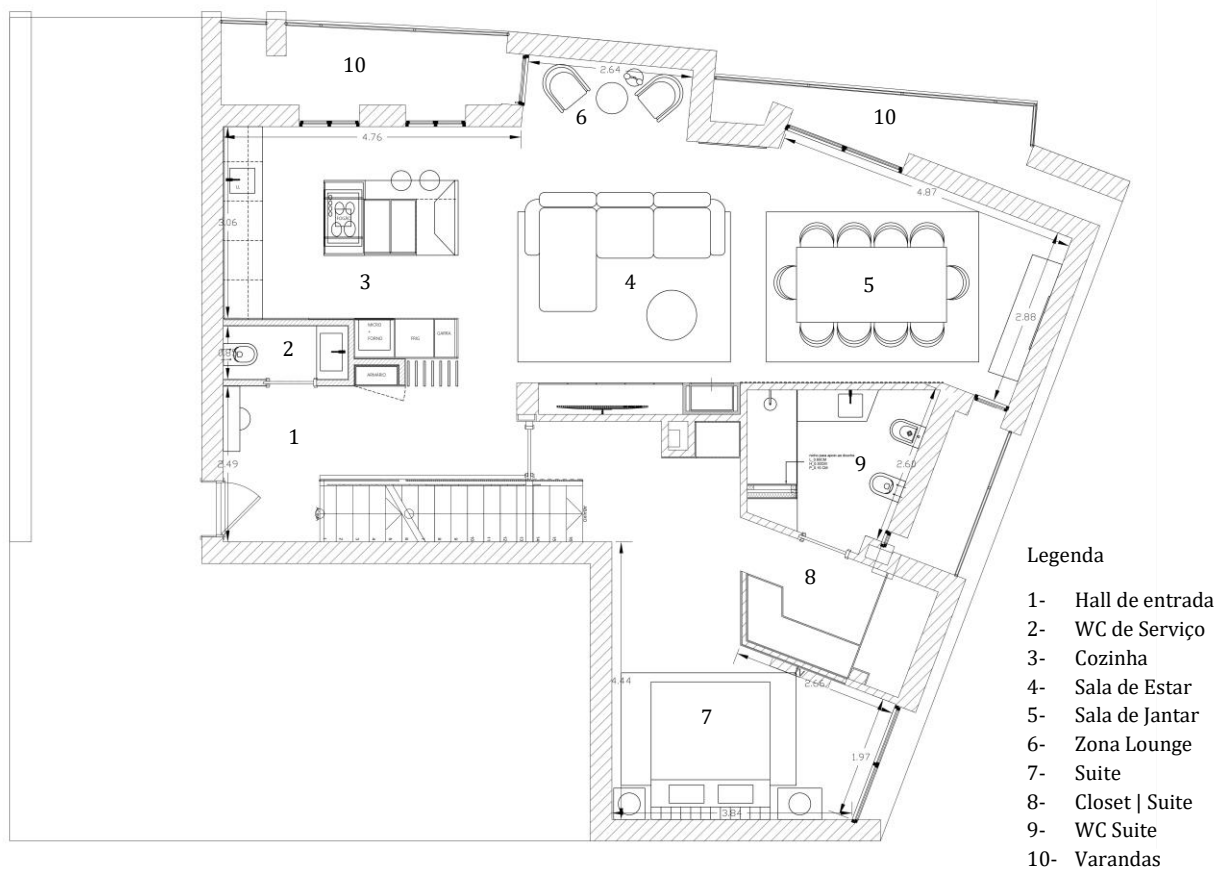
Planta Proposta | Piso 0. Fonte: autora
